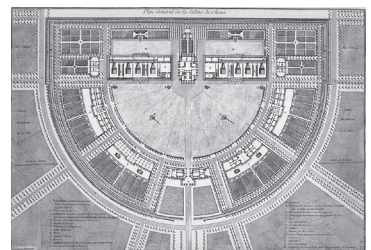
Planta general de las Salinas Reales de Arc-et-Senans, Francia. Primera obra arquitectónica industrial construida entre los años 1775 y 1779.
